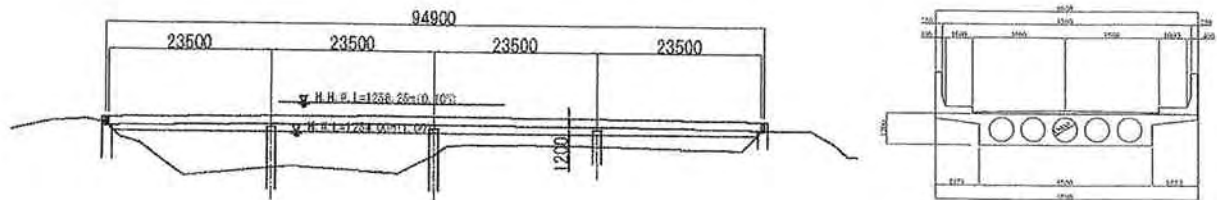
Plan du Pont dalles évidées continues en béton précontraint (longueur de travée : 23,5 m)
